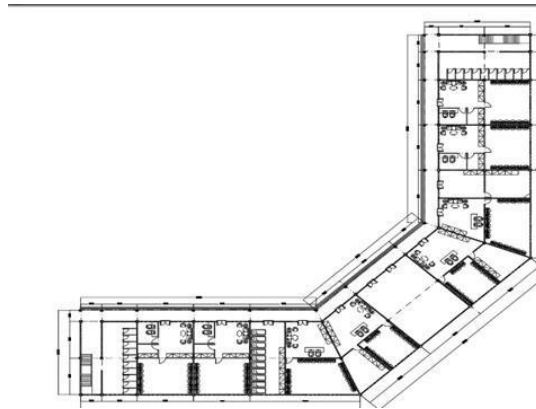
Adopsi konsep denah Fransworth House plan oleh Mies van der Rohe
